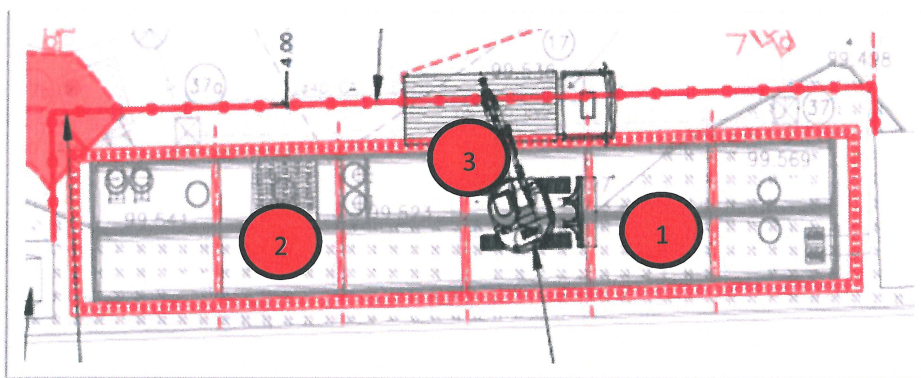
estratto della planimetria di cantiere con ubicazione dei punti di campionamento
